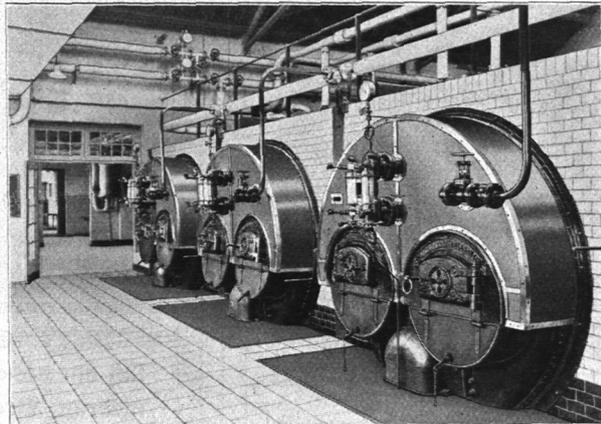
Badeanstalt Hammerbrook, Dampfkeffelanlage.
